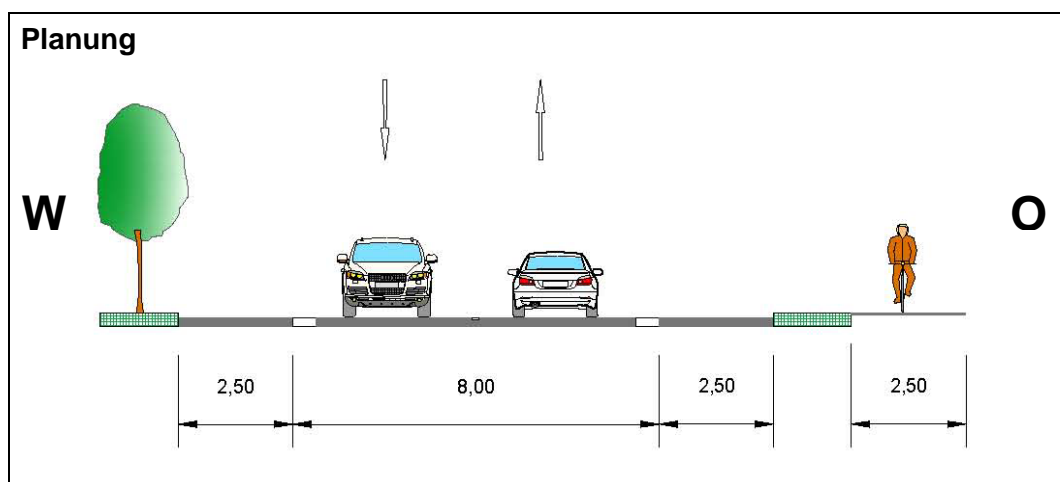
Querschnitt 8 - Lintforter Straße, L 476
